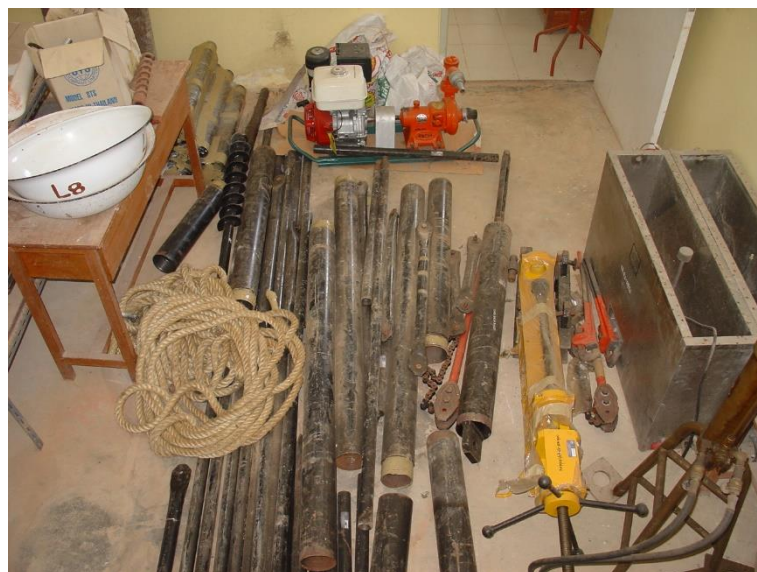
ชุดทดสอบ Pile Load Test
